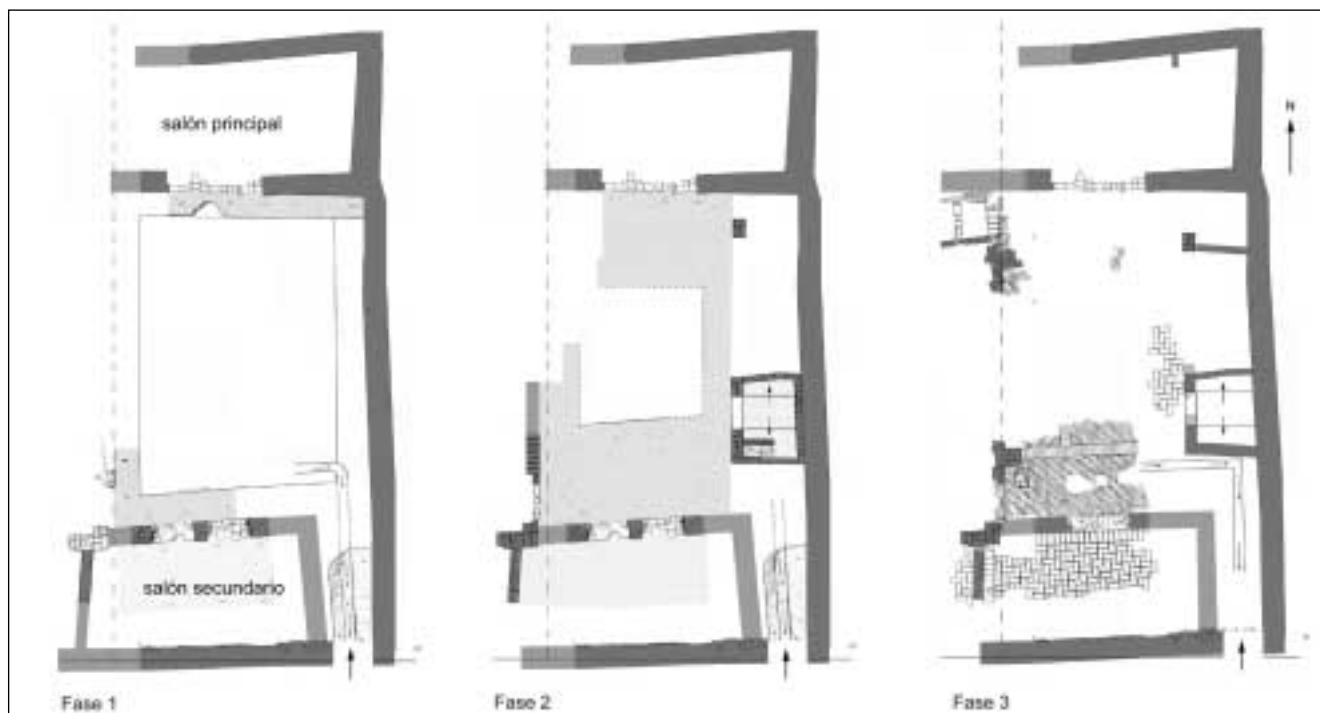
Casa 1, plantas de las fases 1, 2 y 3.
